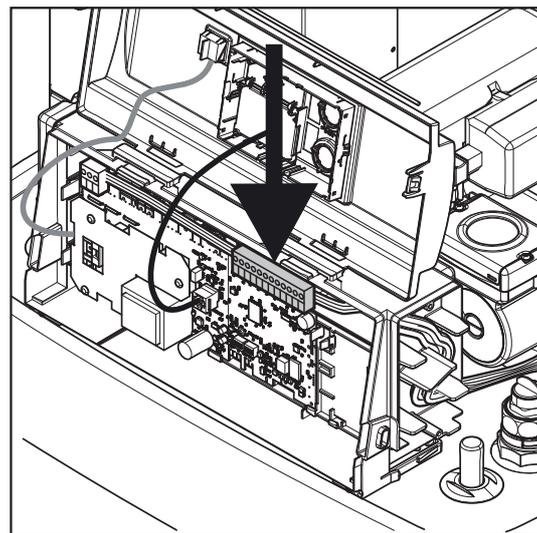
Sensorstecker J8 auf Schaltfeldplatte aufstecken
